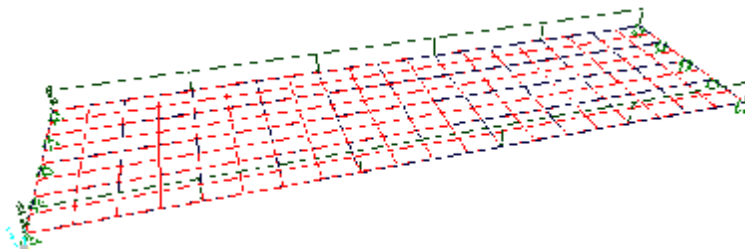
Tampak samping 3D struktur jembatan Model 3 dengan penambahan balok longitudinal diantara balok girder.
